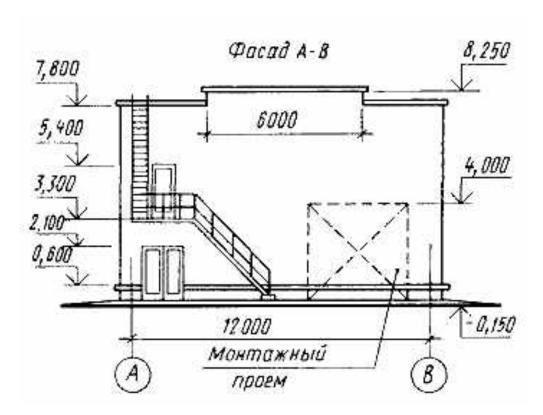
Пример выполнения фасада здания с монтажным проёмом
